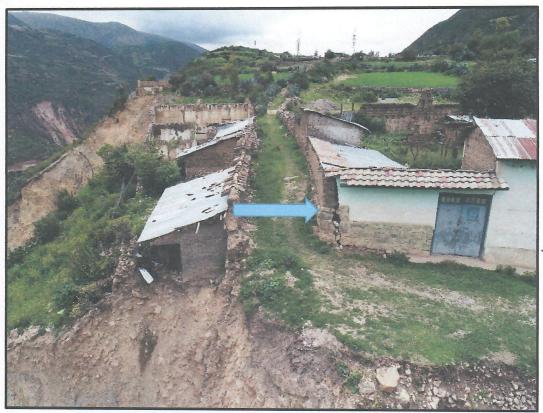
fotografía aérea (Drone), fisuras y agrietamiento en las viviendas afectadas por el deslizamiento de tierra ocurrido años atrás.
